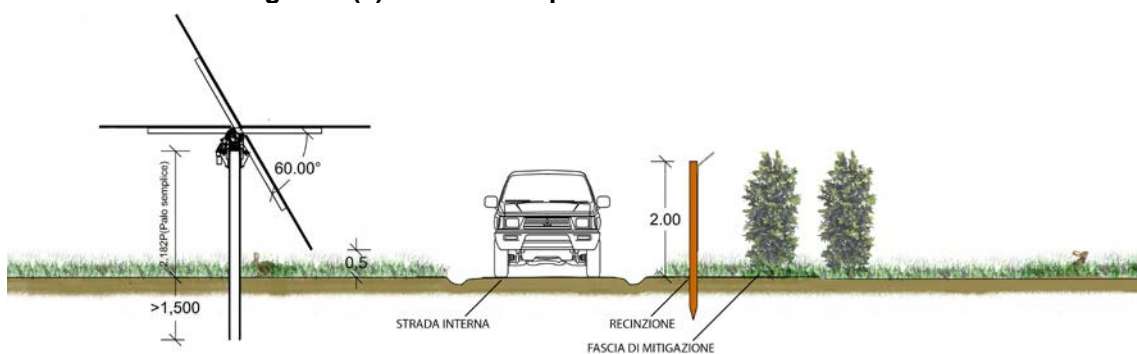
(b) – Fascia di “protezione visiva” – PROSPETTO
